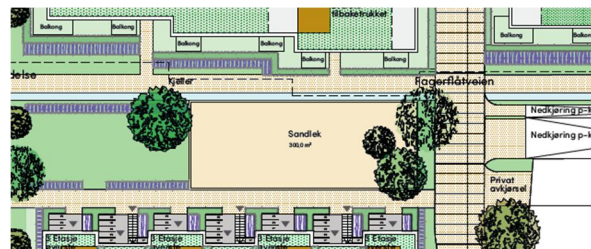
Utsnitt fra illustrasjonsplan - f\_BLK2
